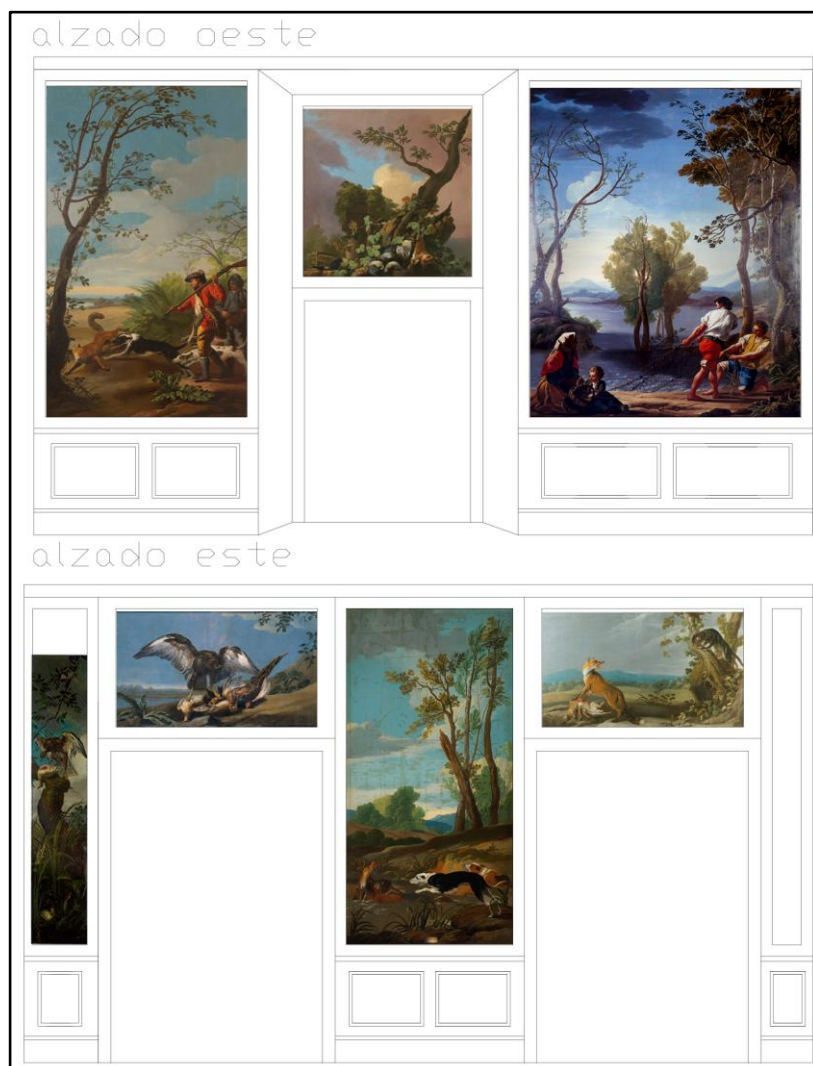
Reconstrucción de los alzados este y oeste de la Pieza de Cámara, según los autores (alzados realizados por Diego Ruiz-Vernacci Lozano).
